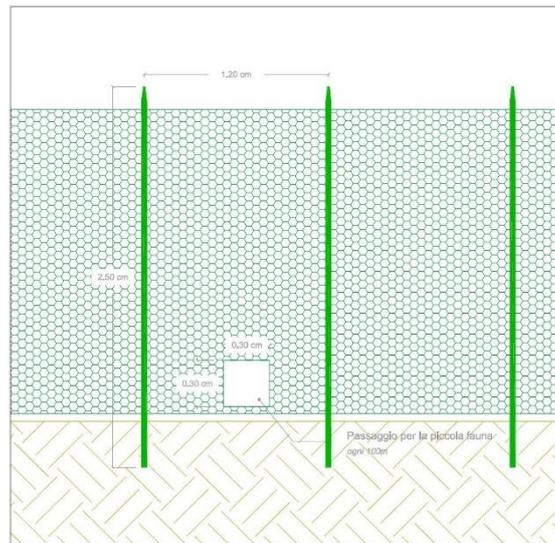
Particolare recinzione passaggio piccola fauna
